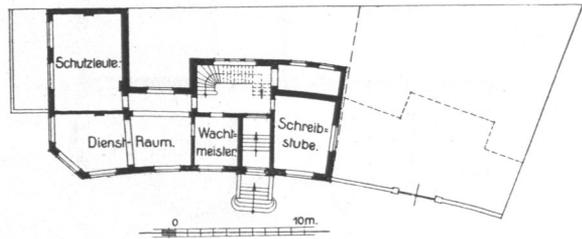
Polizeiwache Hammerdeich, Erdgeschoß, Grundriß.
